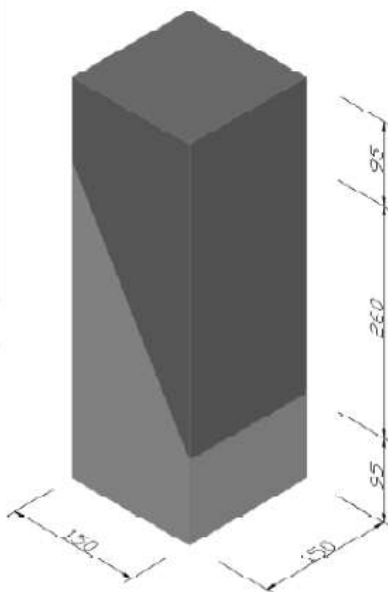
Dimensões, em *mm*, dos provetes de corte inclinado.
